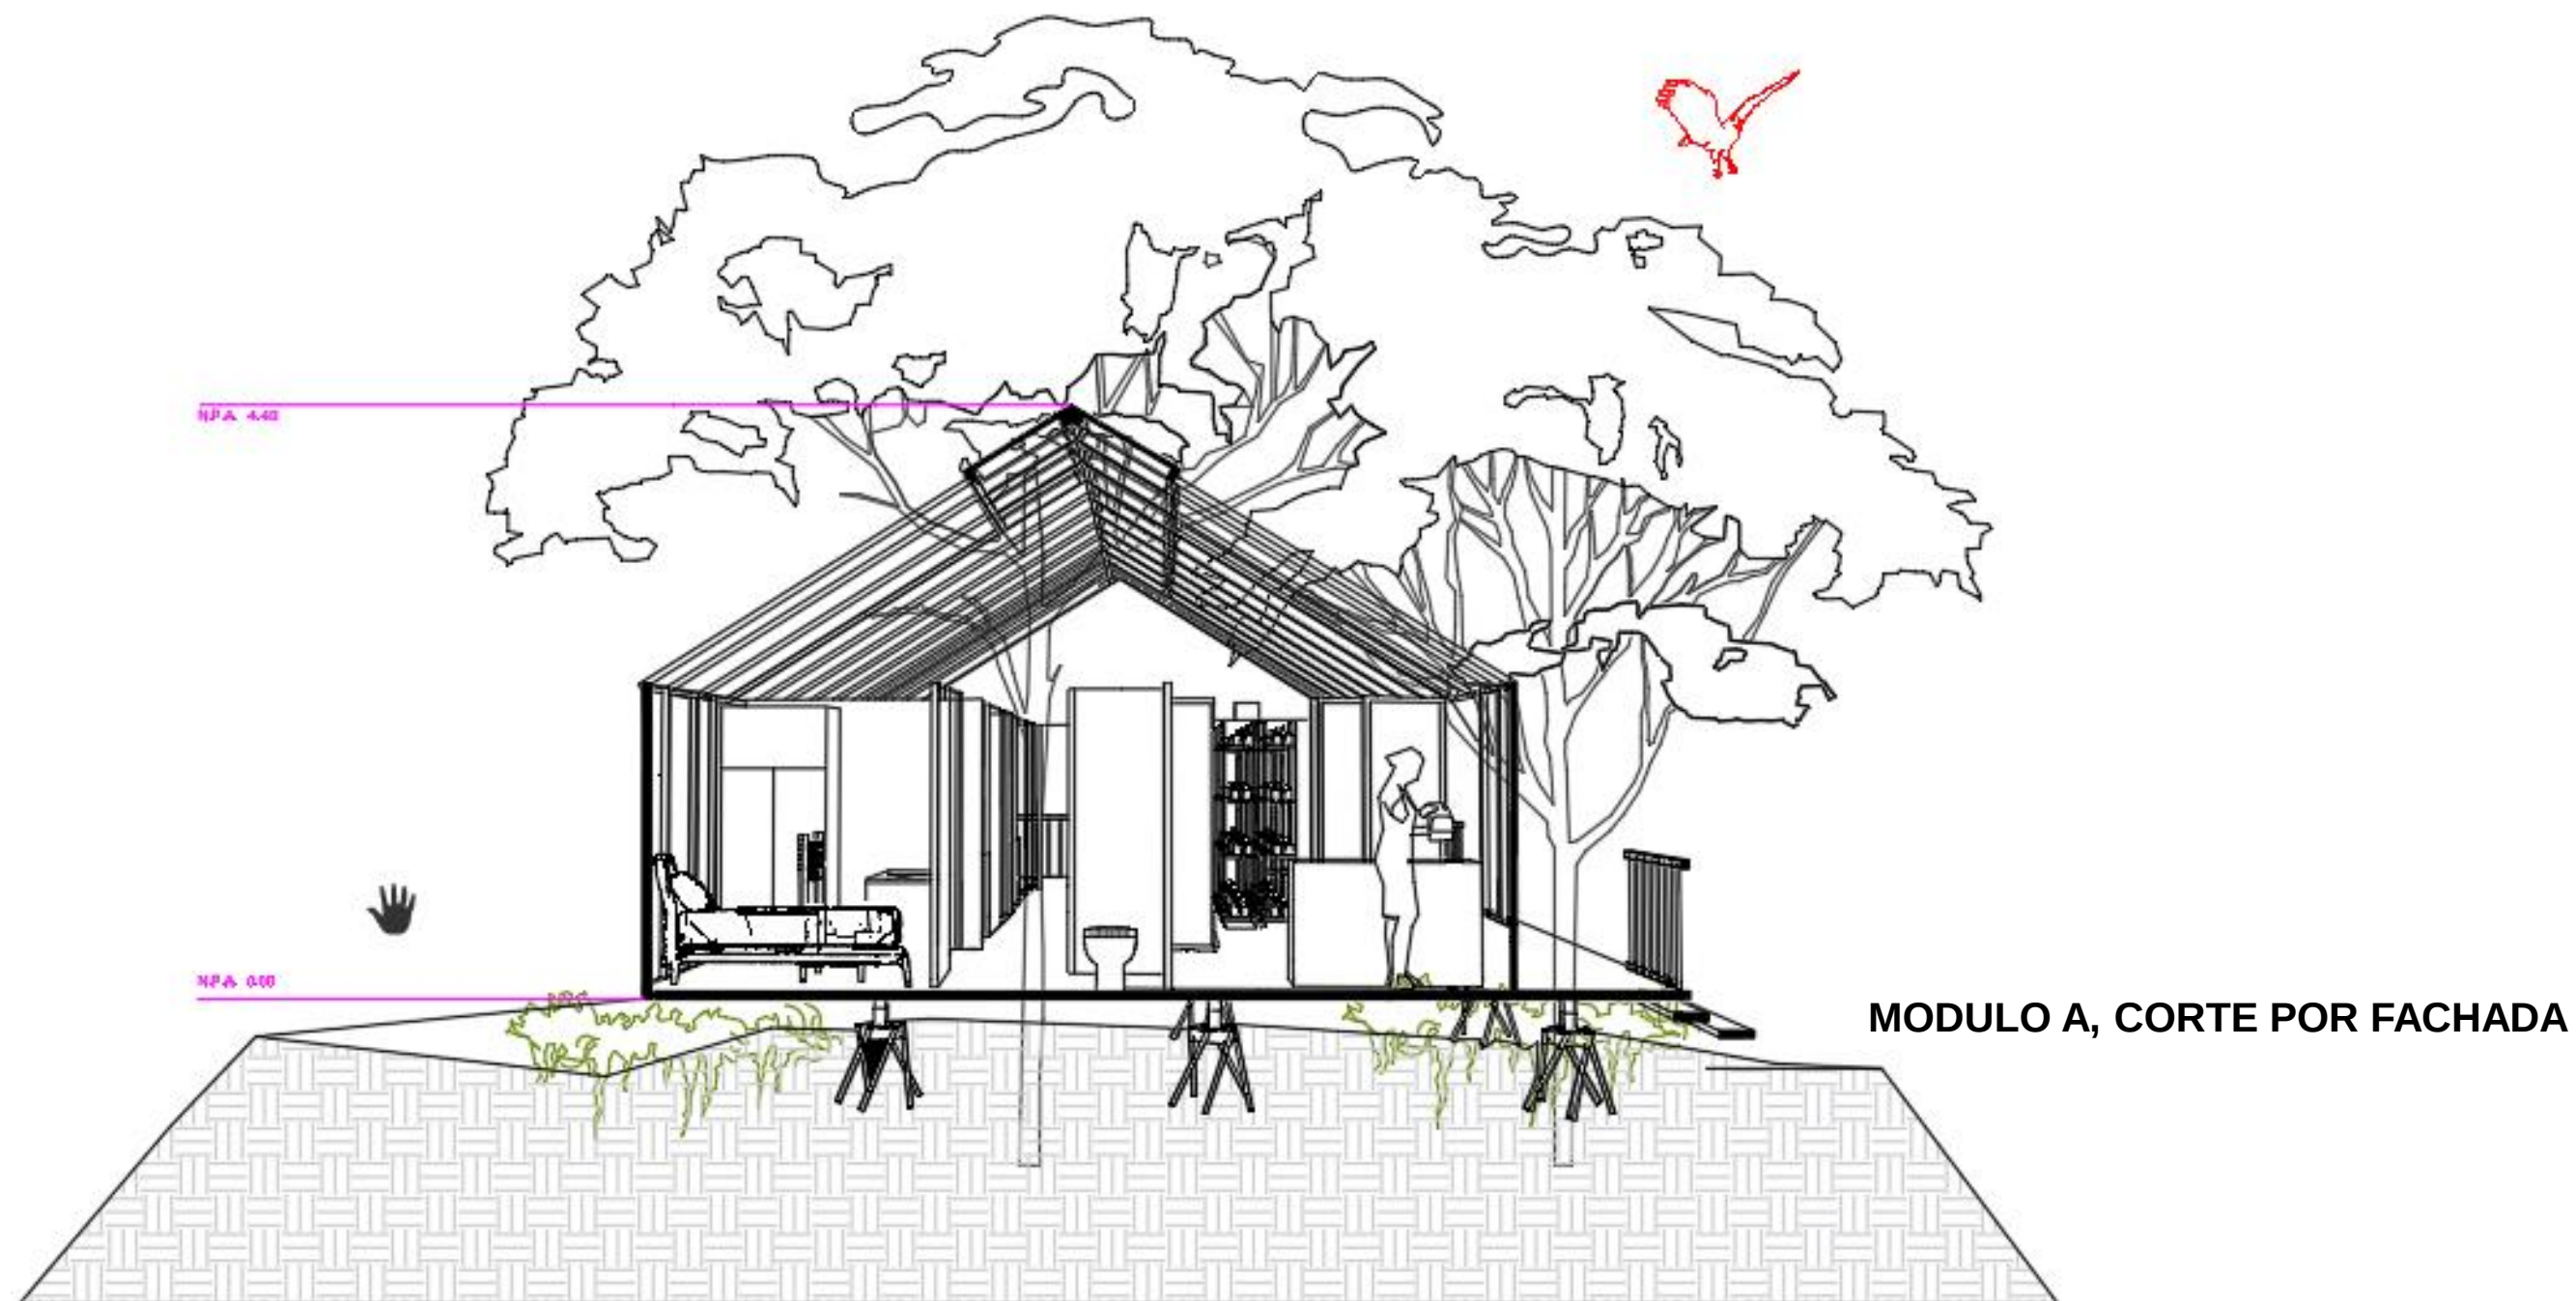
Corte por fachada, alzados y detalles, John Fredy Jaramillo
